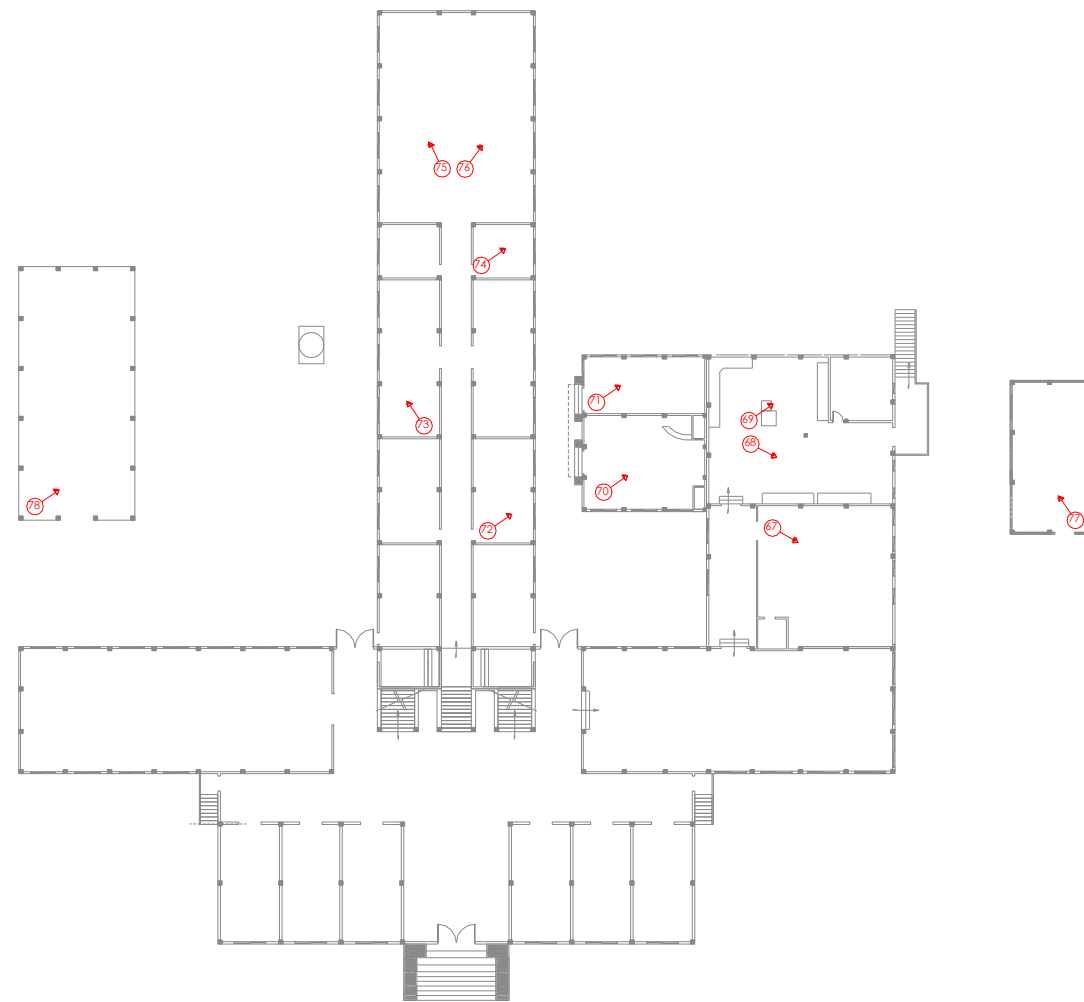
Planta Baja: Ubicación de vista de fotografía (67-78)
